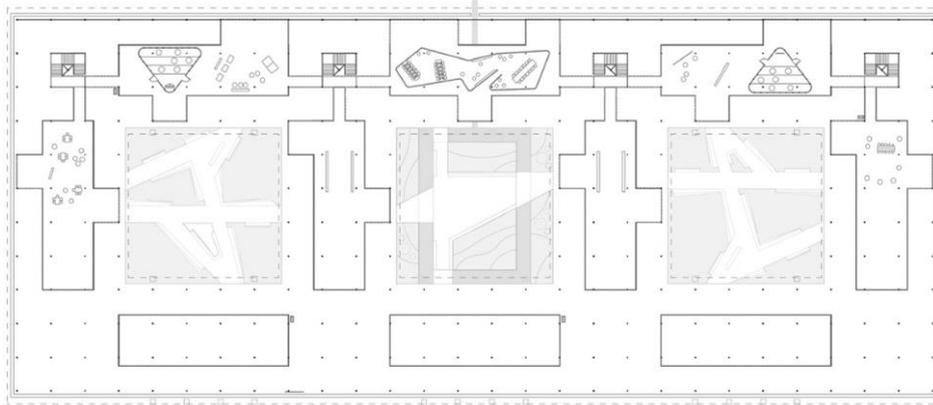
Moradias Infantis – Planta Baixa do Térreo.
